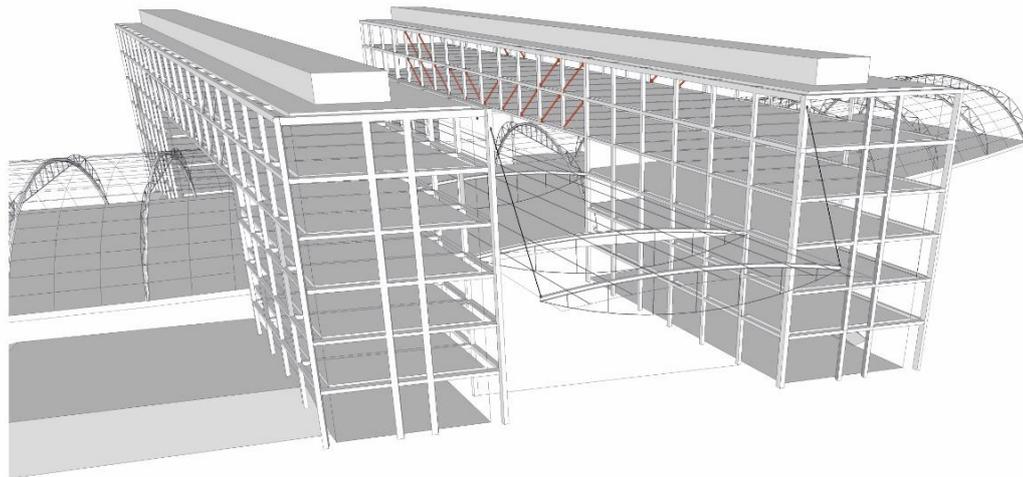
Elementos estructurales de ingreso a la estación Berlín.
